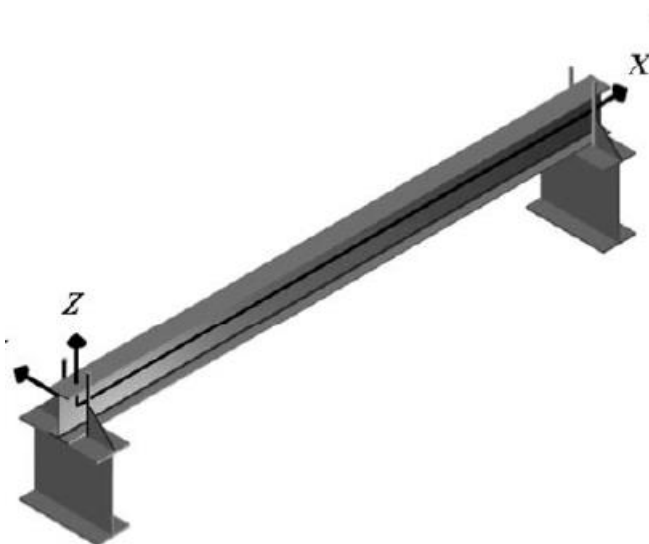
Modelo viga simplesmente apoiada nas extremidades em apoios em forquilha (Vila Real et al., 2007b).
